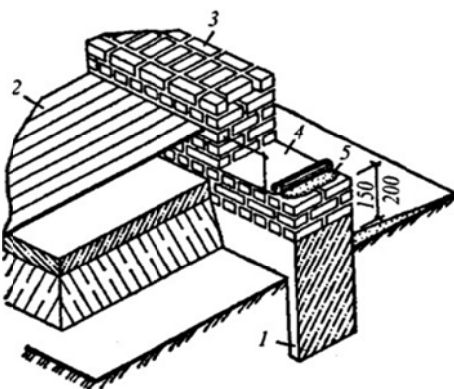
Горизонтальная гидроизоляция в зданиях без подвала:
